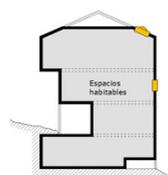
cerramiento fachada norte. 2022 . Fuente propia
